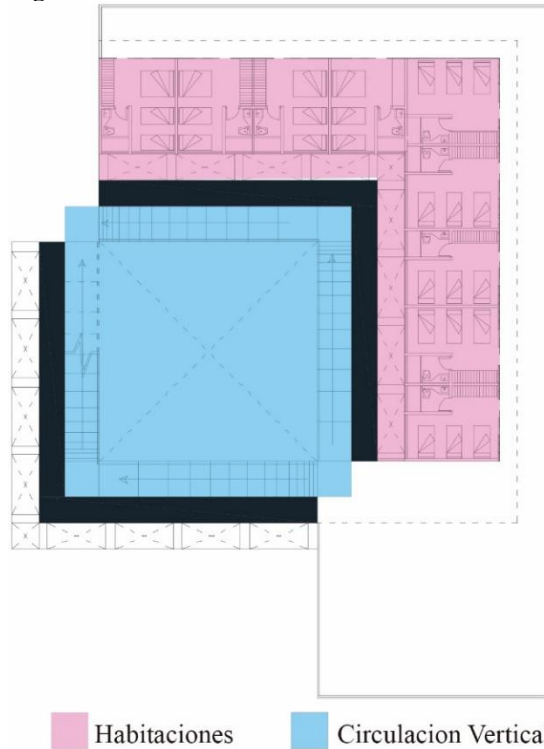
Zonificación Planta Habitaciones y Construcción Actual
